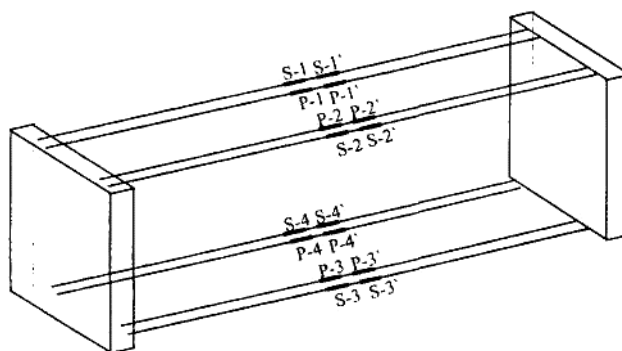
Схема розташування тензорезисторів на арматурах А–ІІ, АІ–V
